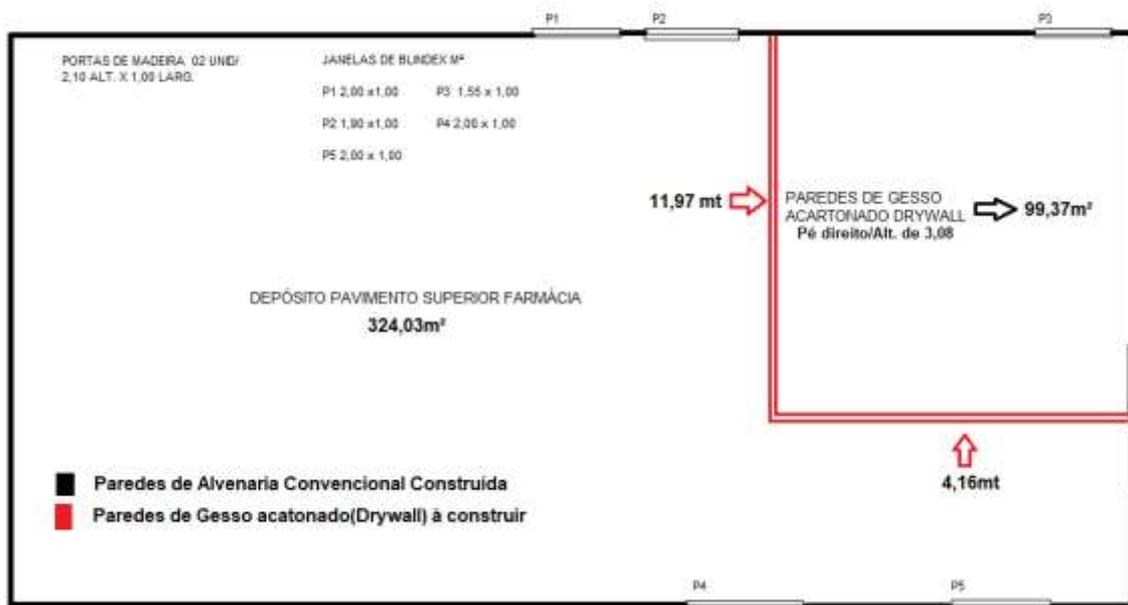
Projeto Planta Baixa de construção de 01sala de Drywall sobre o pavimento da edificação - Fonte :O autor,(29/10/2021)
